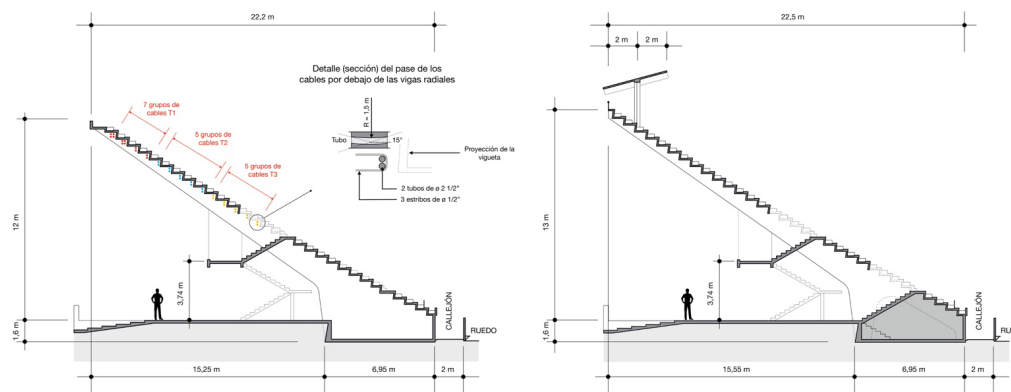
A la izquierda, propuesta estructural de octubre de 1955 para la plaza de toros de Cali, con macizo de apoyo para las vigas radiales y acceso a la gradería mediante un vomitorio; se muestra también la disposición de los cables de tensionamiento (que debían interrumpirse en los tramos de los vomitorios). A la derecha, propuesta de abril de 1956 en la que aparecen vomitorios inferiores y una cubierta sobre las últimas seis filas; el sistema de postensado no sufría variaciones. Fuente: elaboración propia a partir de los planos PLE-22 y PLA-18, respectivamente, que se conservan en el Fondo González Zuleta del Archivo de Bogotá.
